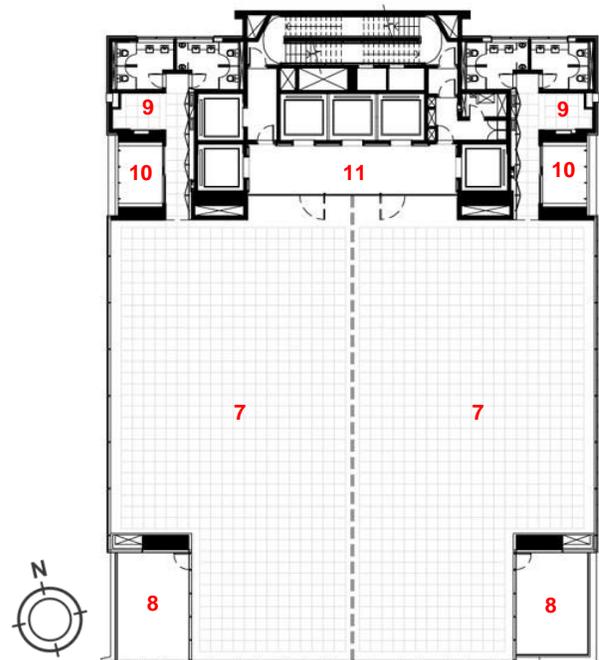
Edifício JK 1600 - Planta Baixa – Pavimento tipo.
